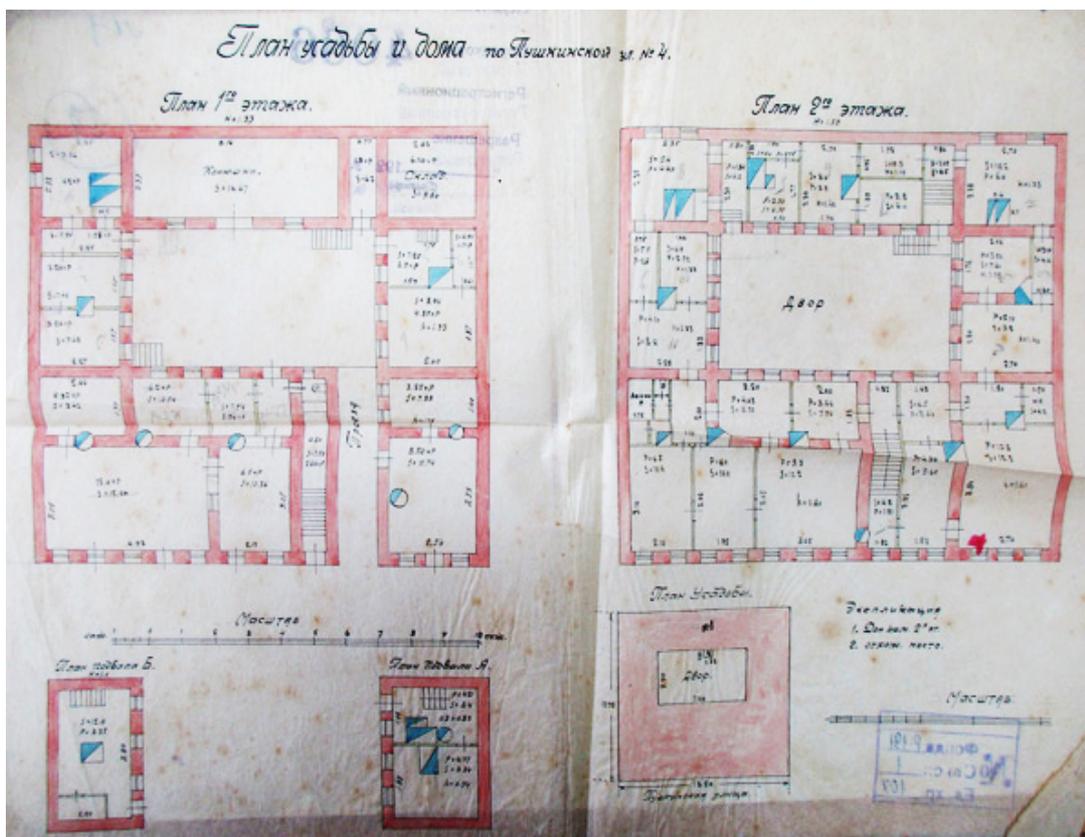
План усадьбы, поэтажные планы дома в Екатеринбурге по ул. Пушкинской, 4 (ныне – ул. Пушкина, 4)⁷
